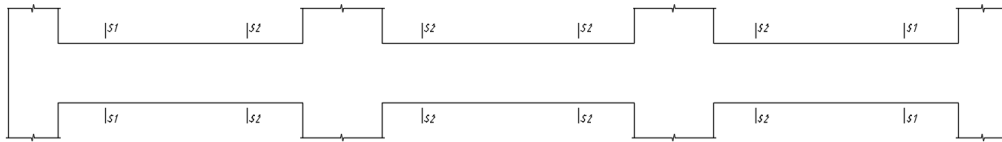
Secciones de diseño de viga sismática. Fuente: Propia.
